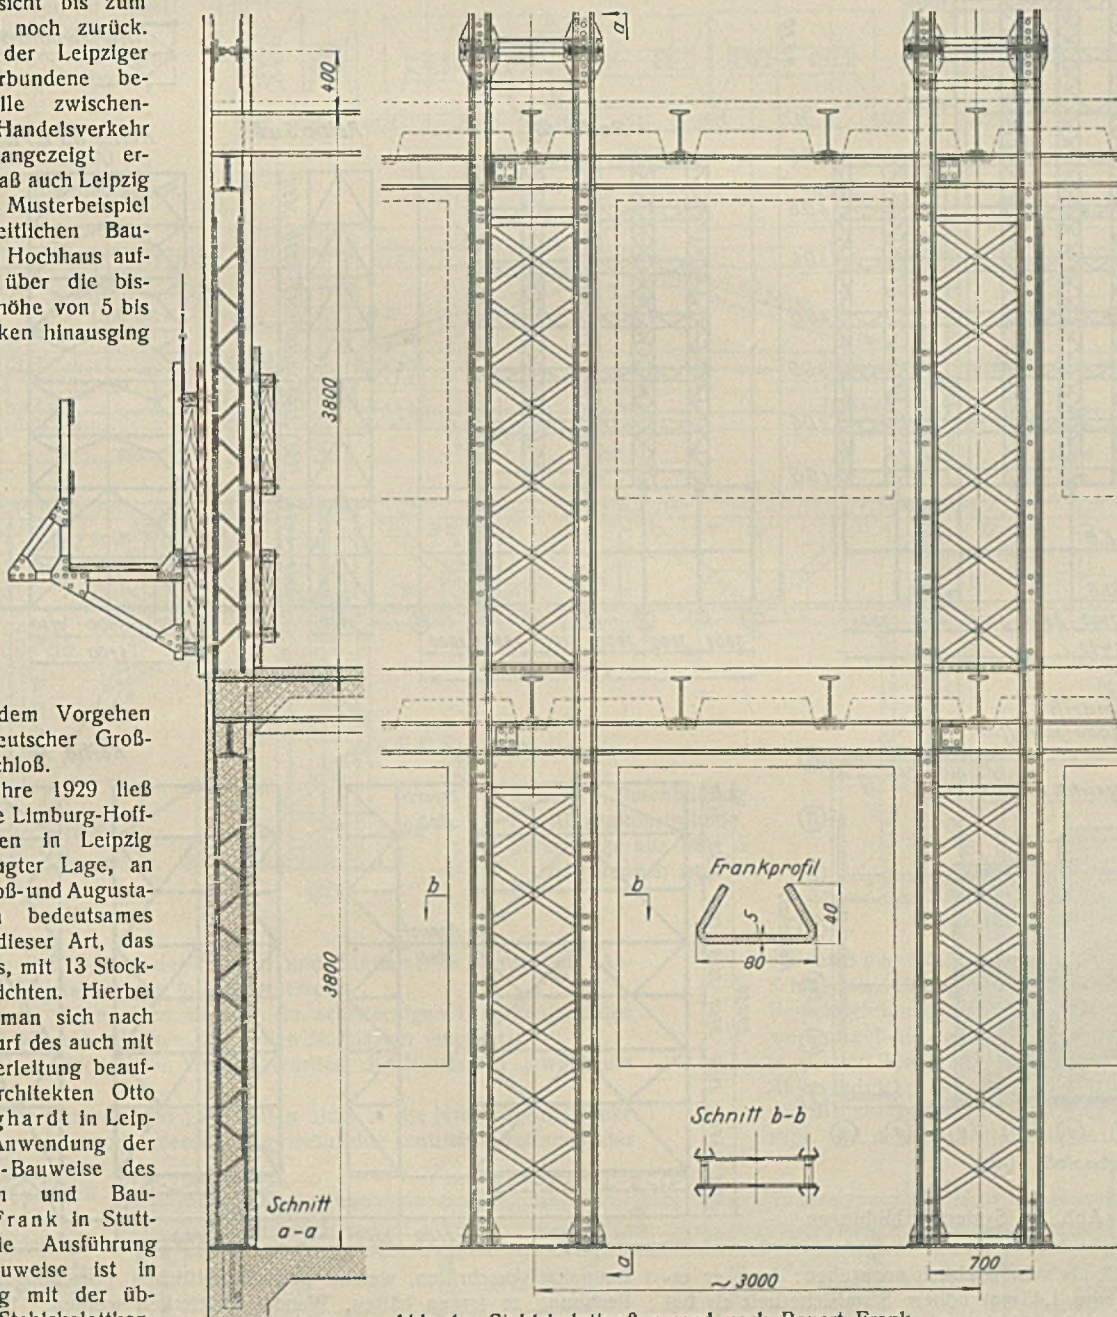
Stahlskelettaußenwand nach Bauart Frank.
